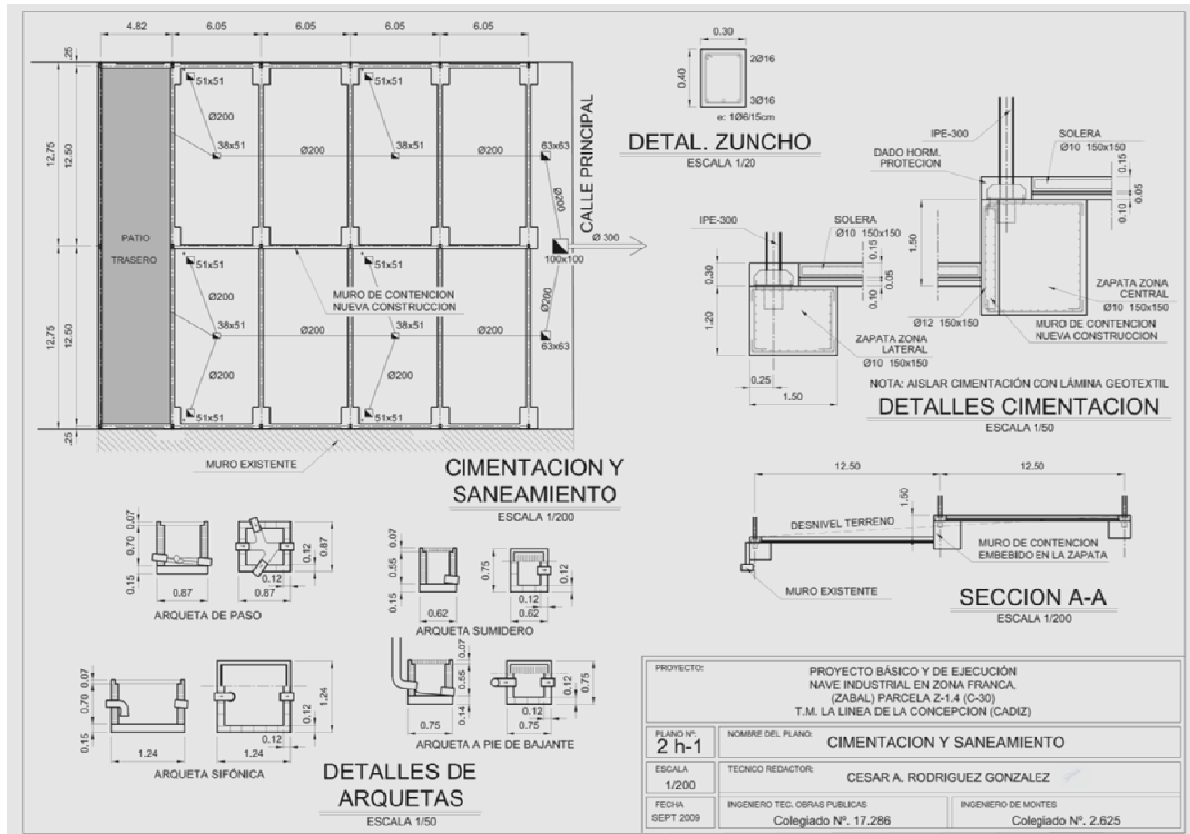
Caso de Estudio 7: Nave industrial para almacén. Plano de Cimentación
